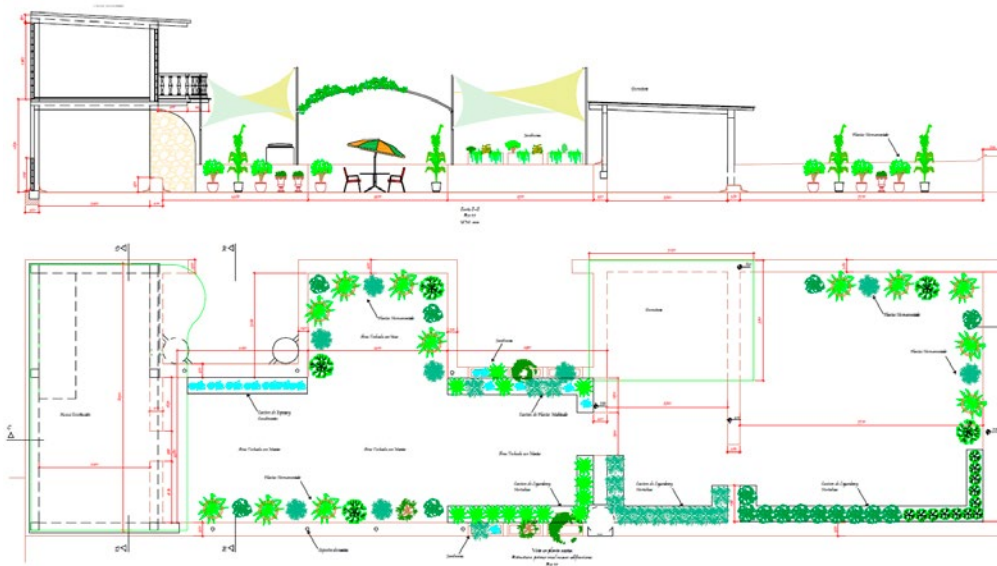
Elevación y planta de la azotea de la vivienda, fuente: elaboración propia.
